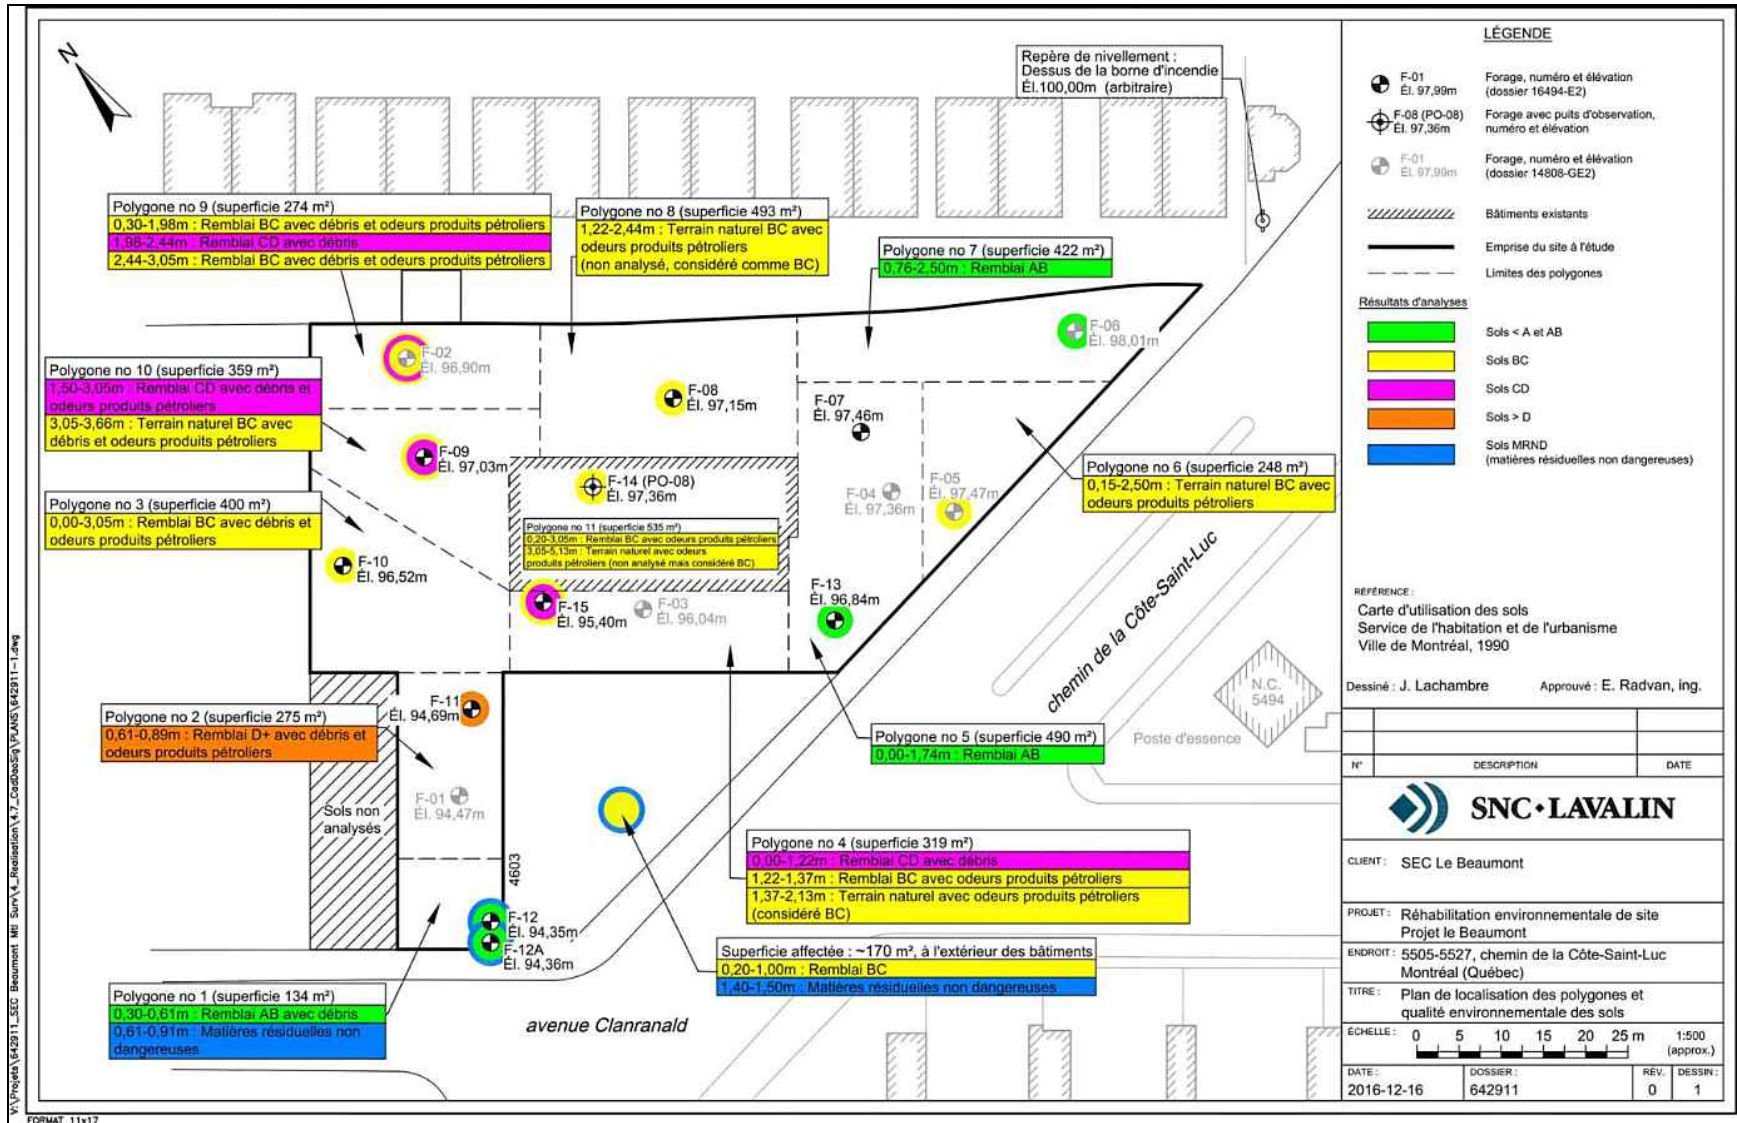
Plan des zones de contamination des sols [SNC-Lavalin, 16/12/2016]
